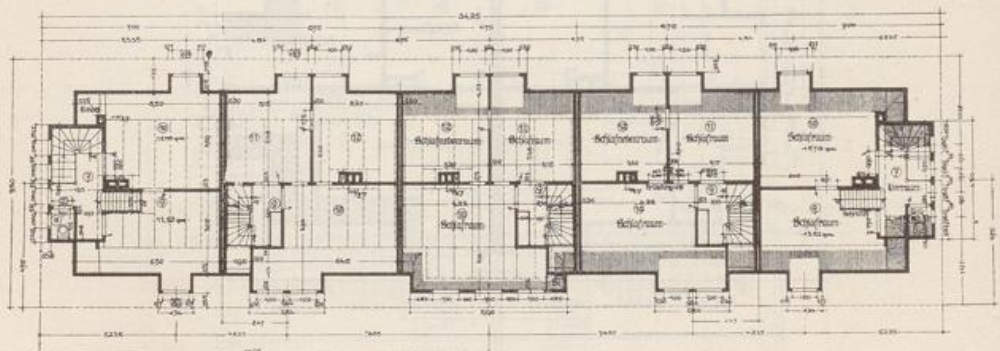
Grundriß zu Abb. 85. Dachgeschoß.
